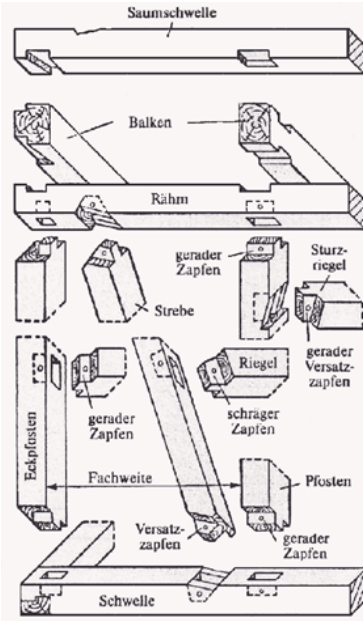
Detalles de uniones carpinteras en sistema constructivo Fachwerk. Fuente: Stade (1904).
